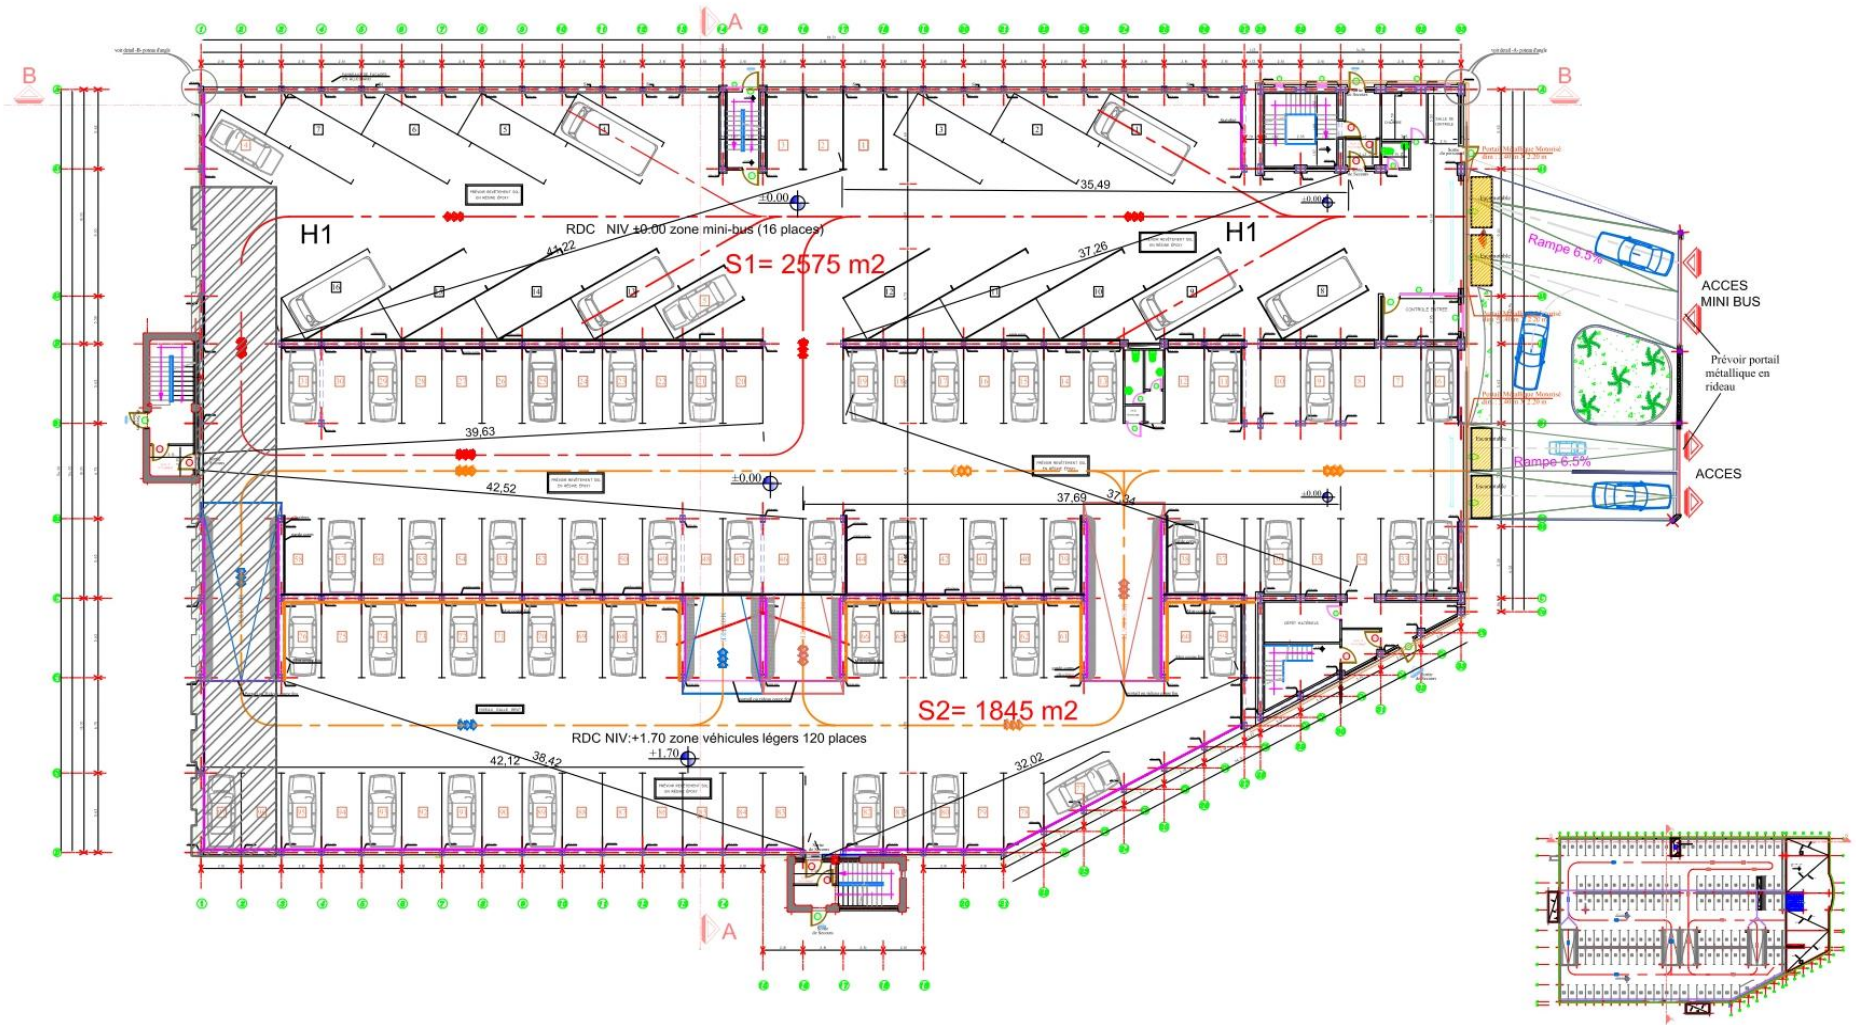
Plan d'architecture du Rez-de-chaussée [Autodesk AutoCAD 2023]
